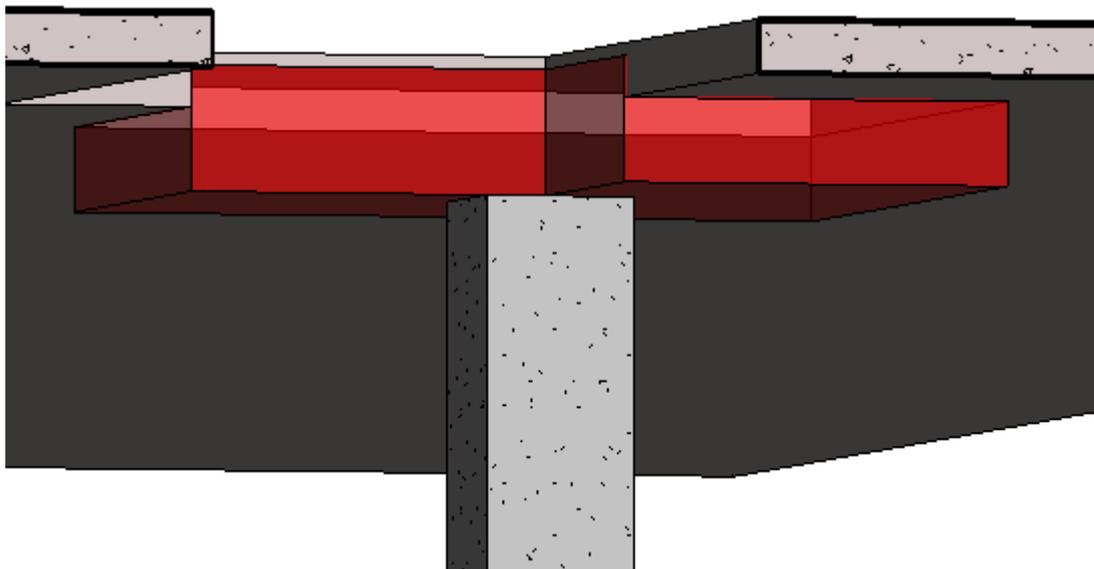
Capitel modelado de manera que atraviesa la losa de entepiso
